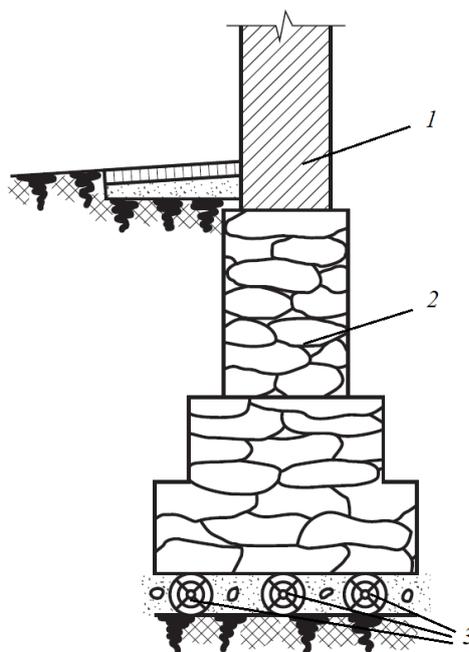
Поперечное сечение фундамента с продольными лежнями по [10]:
